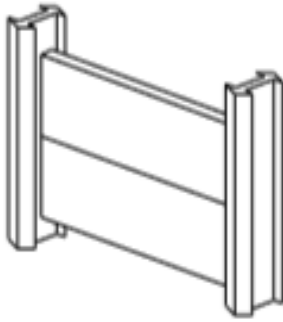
Poteaux et plaques en béton (NF EN 14475)
